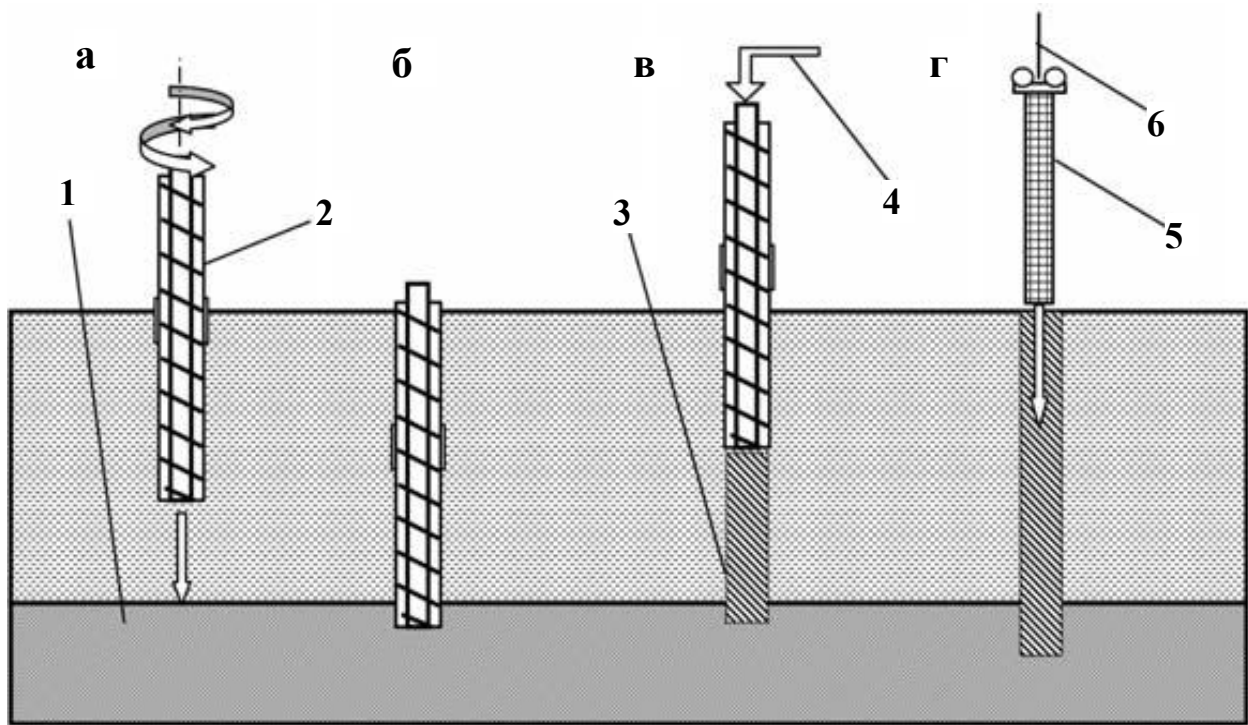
Технологічна послідовність улаштування палі: а, б – буріння на проектну відмітку; в – витягування шнека з одночасним заповненням бетоном свердловини; г – вібраційне установлення арматурного каркаса в бетонний стовбур; 1 – несучий шар ґрунту; 2 – обсадна труба з прохідним шнеком; 3 – свердловина в ґрунті, заповнена бетоном; 4 – напрям подавання бетону в свердловини через порожнину шнека; 5 – арматурний каркас; 6 – вібратор на гаку-крані
